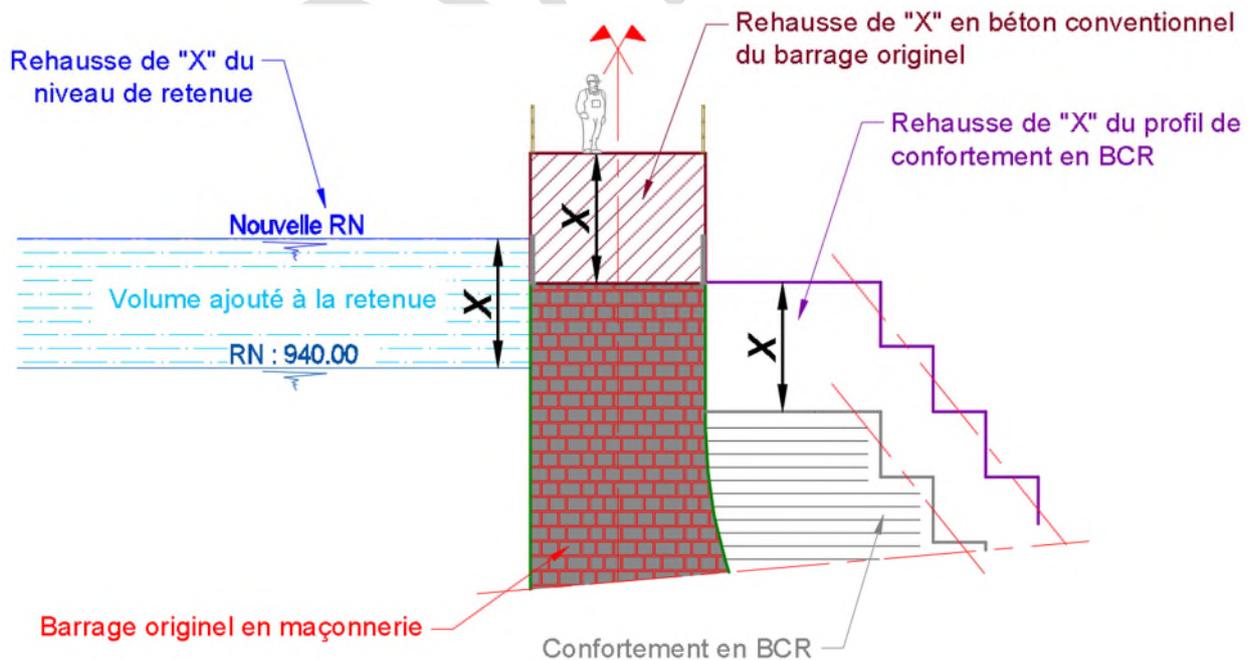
Coupe-type du principe de réhausse au barrage de la Lauch
